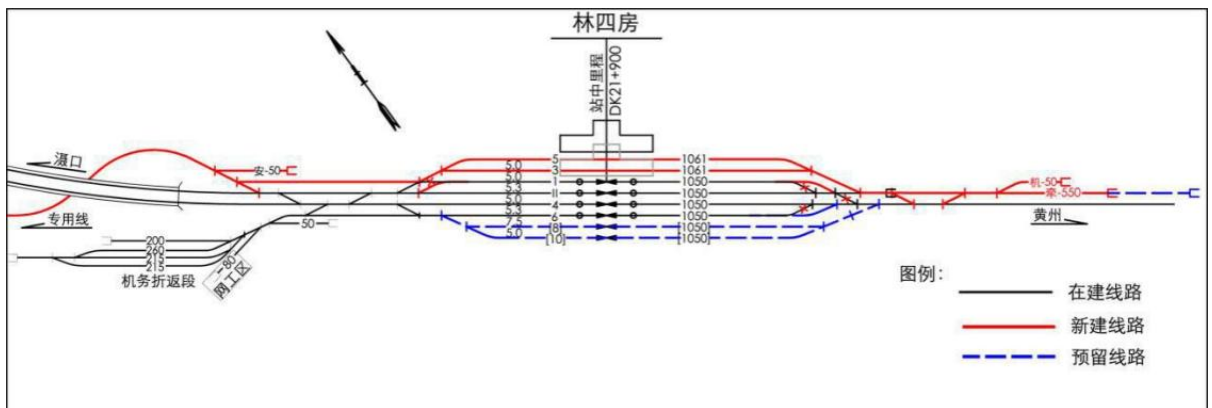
林四房站西咽喉北侧接轨平面布置示意图
